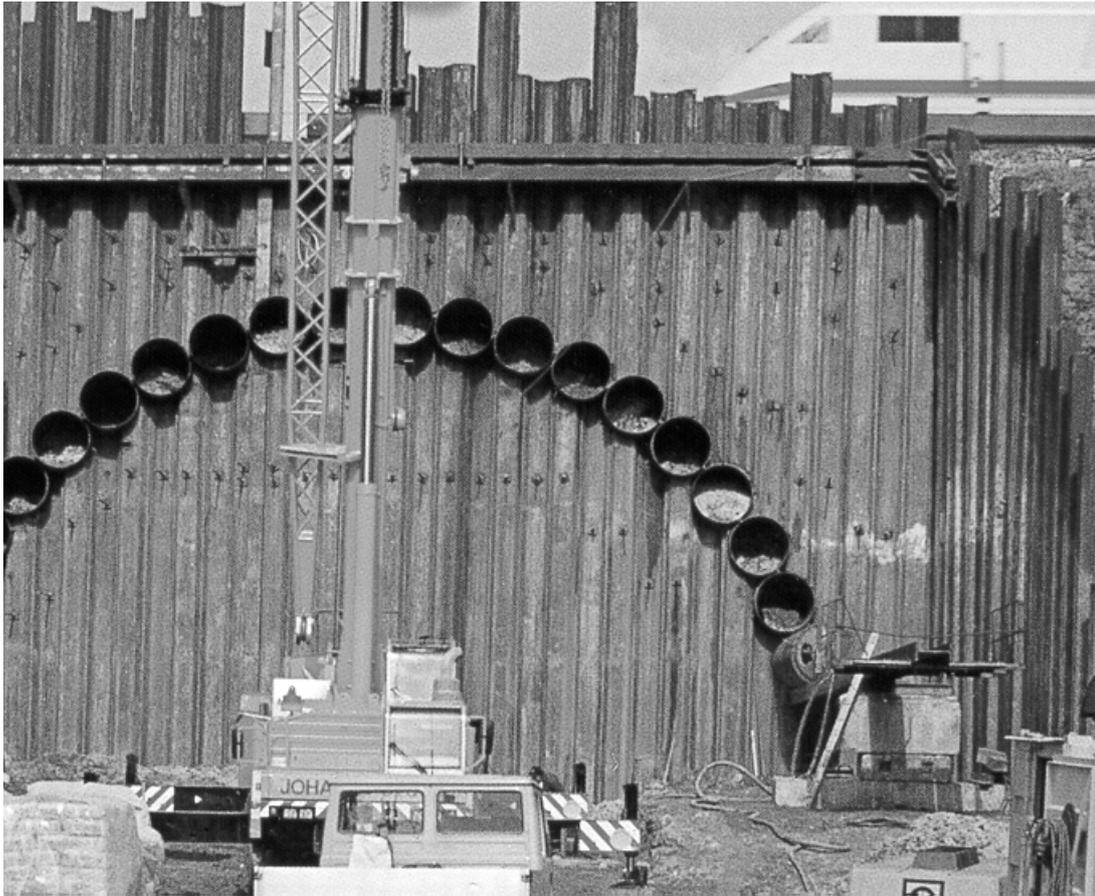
Anwendungsbeispiel: Rohrschirm aus 44 Stahlrohren für Bahndammunterführung [1]
